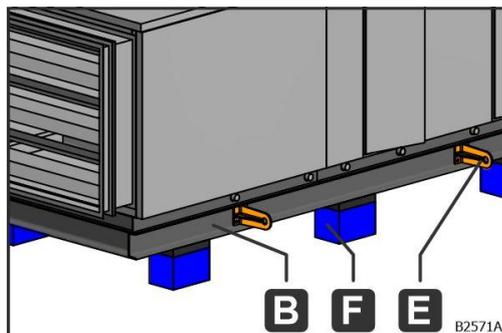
Fondations ponctuelles pour centrales sur châssis DIN (désignations)
